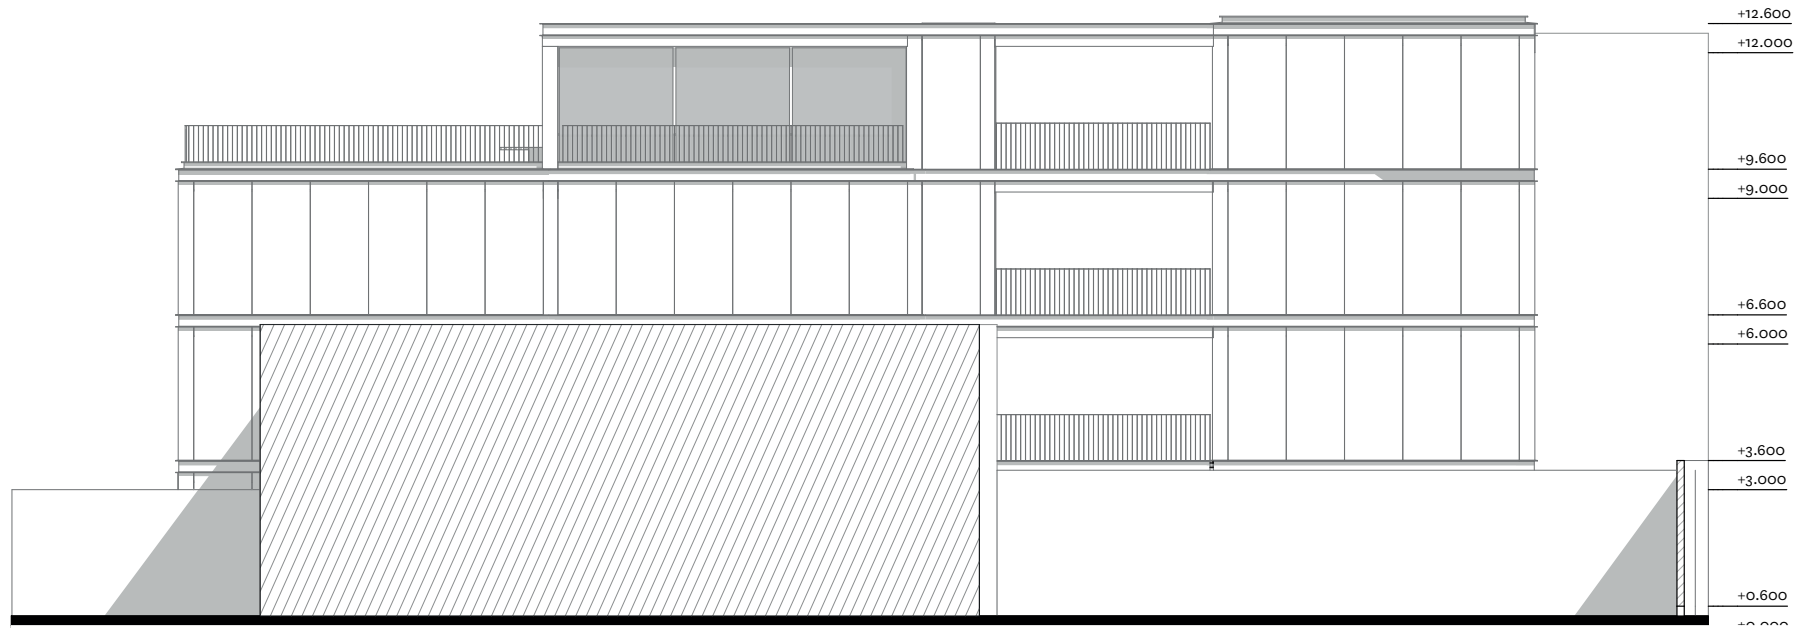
Elevación Este. Elaboración autor tesis.
